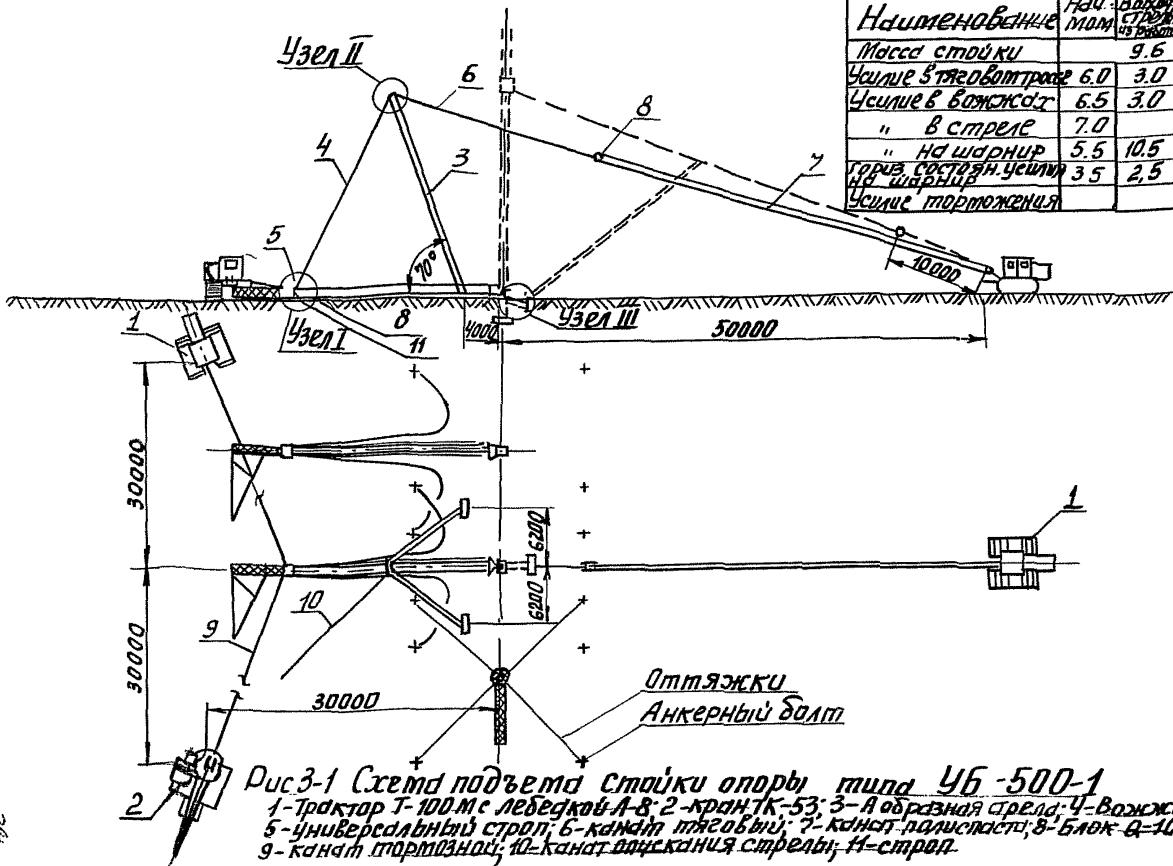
Схема подъема стойки опоры тунда УБ-500-1
